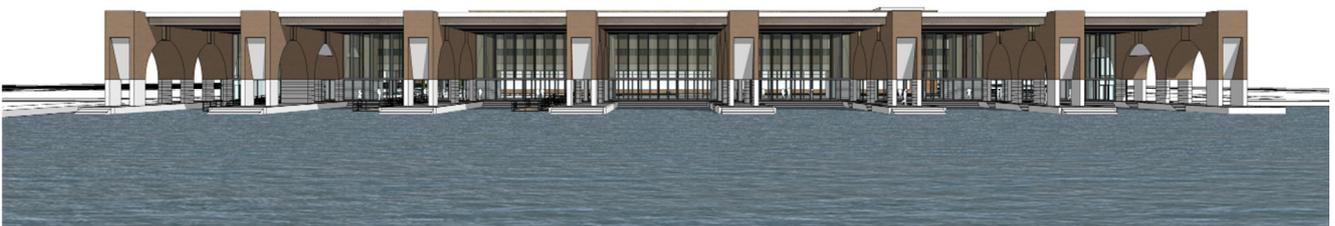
Vista dall'acqua dell'edificio di progetto
